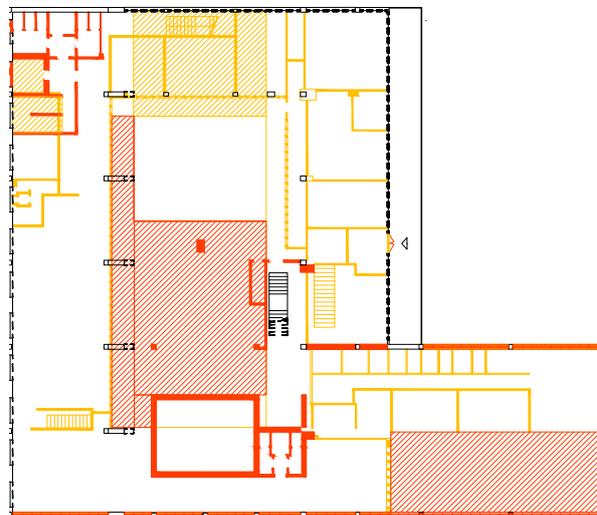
Planimetria demolizioni e costruzioni - Piano primo.
